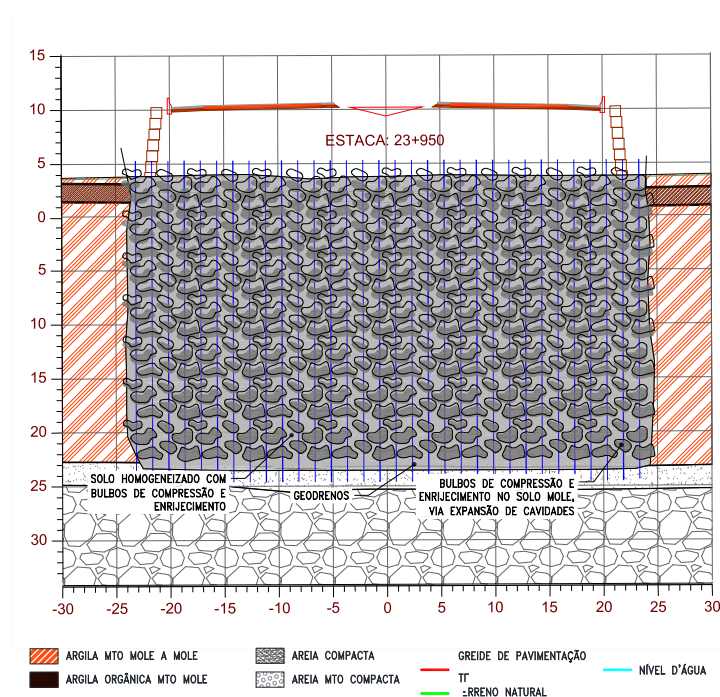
Corte transversal da Estaca 23+950 com Geoenrijecimento.
